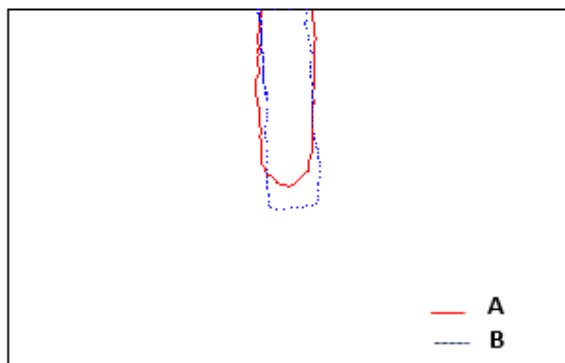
Caixa 4: comparação das colunas executadas com pilão tipo A e pilão tipo B
